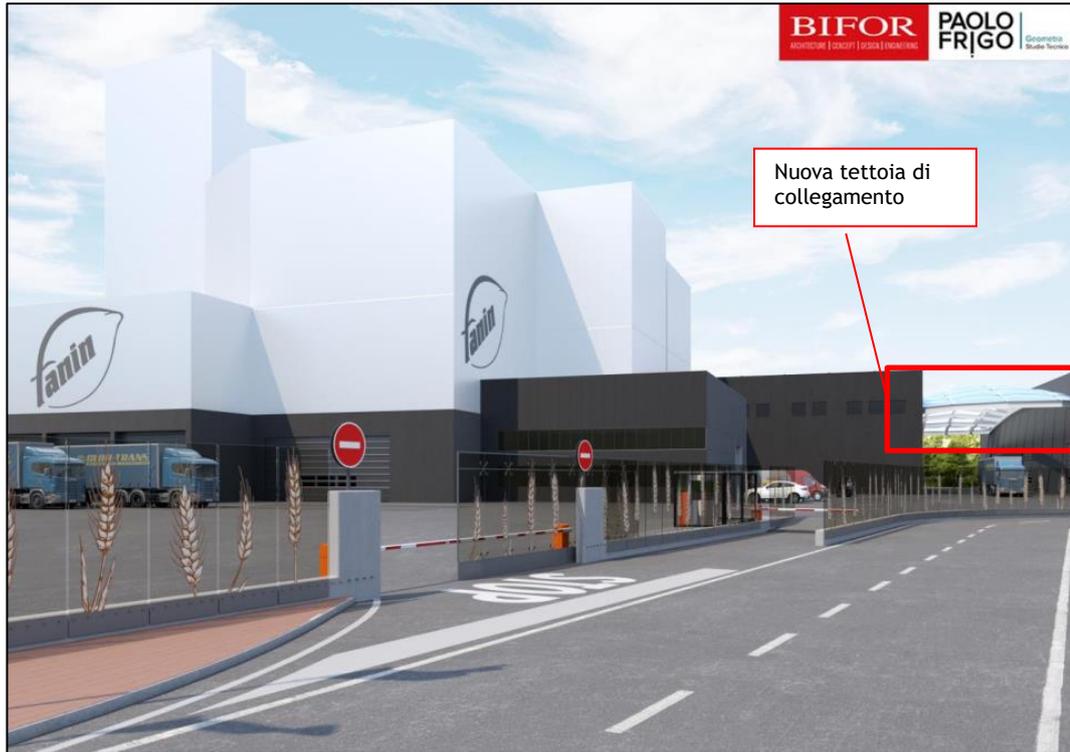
FOTOINSERIMENTO DELL'EDIFICIO CON LE MODIFICHE PROPOSTE
